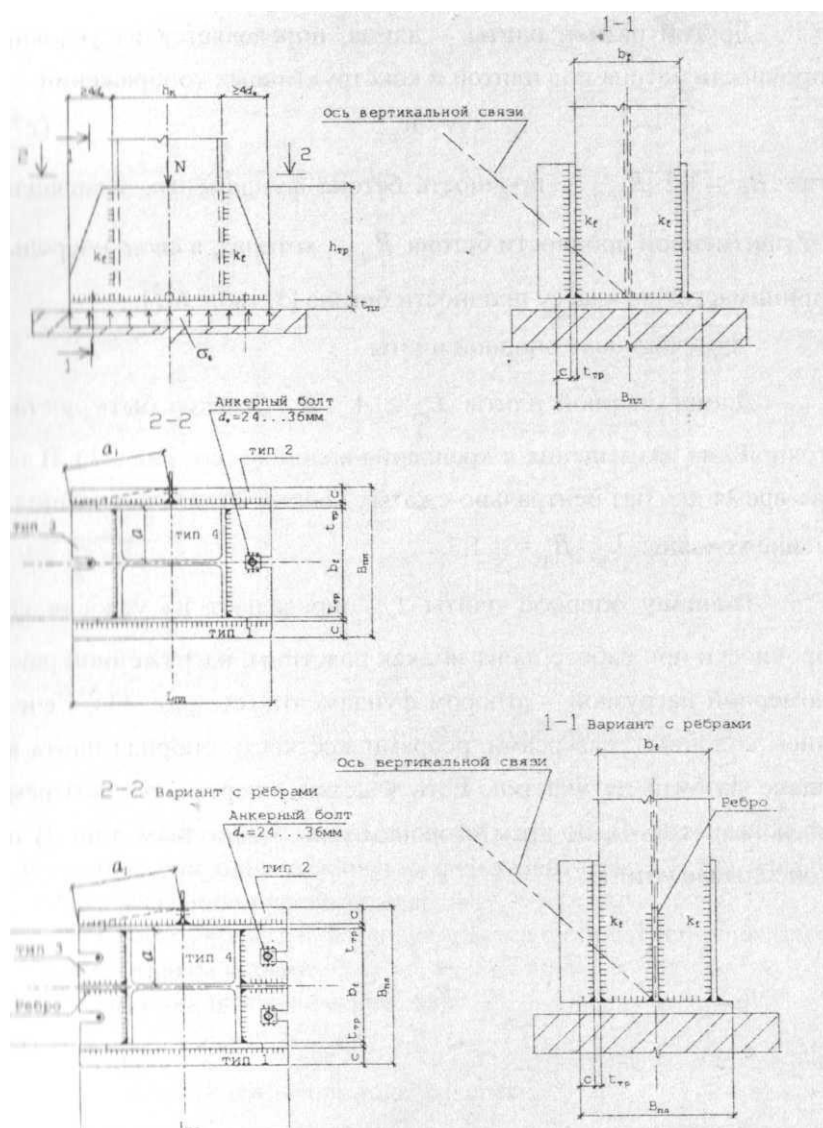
К расчету базы колонны при шарнирном сопряжении с фундаментом
